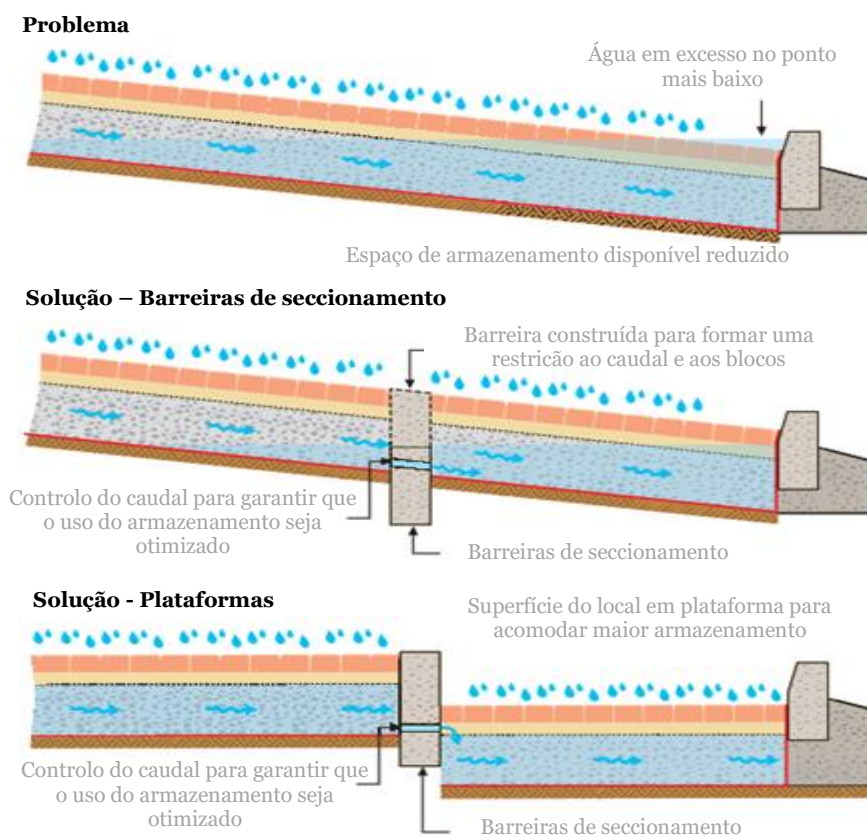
Soluções para pavimentos permeáveis em locais inclinados (Adaptado de Interpave, 2010)
